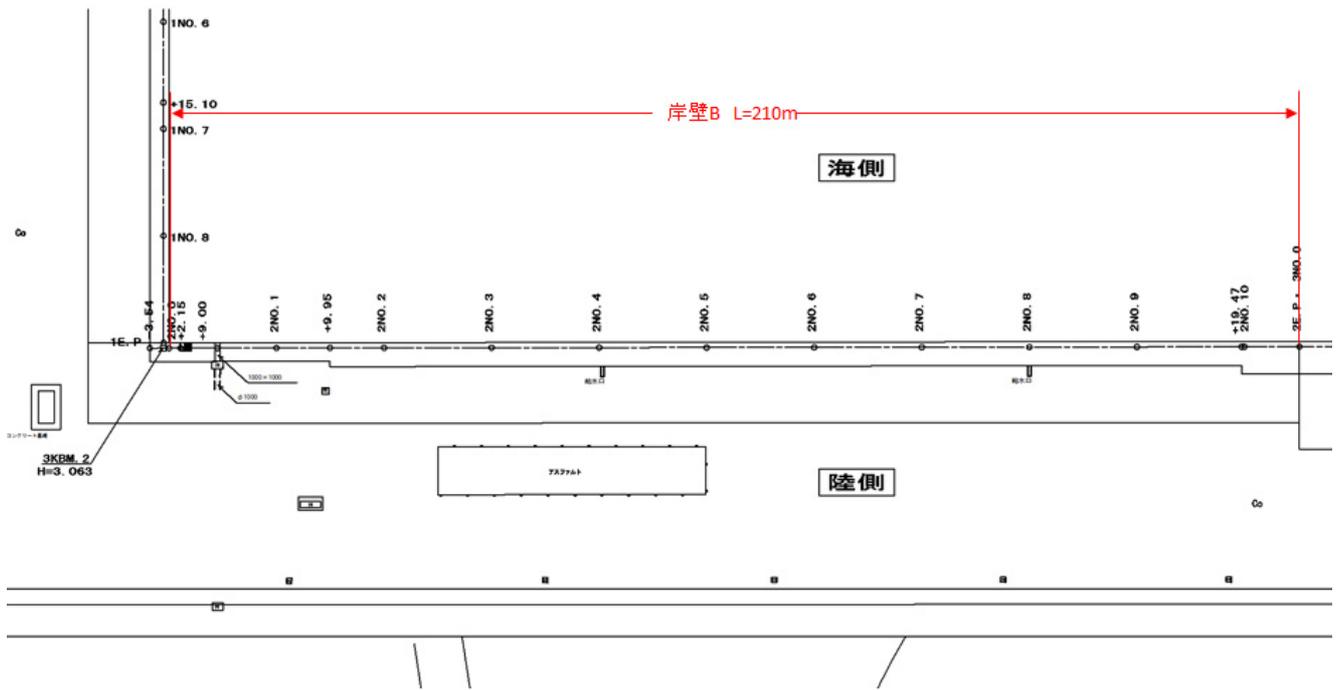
244 No.22 常陸那珂港区_南埠頭地区 B岸壁 (-5.5m) の平面図 (被災前)
